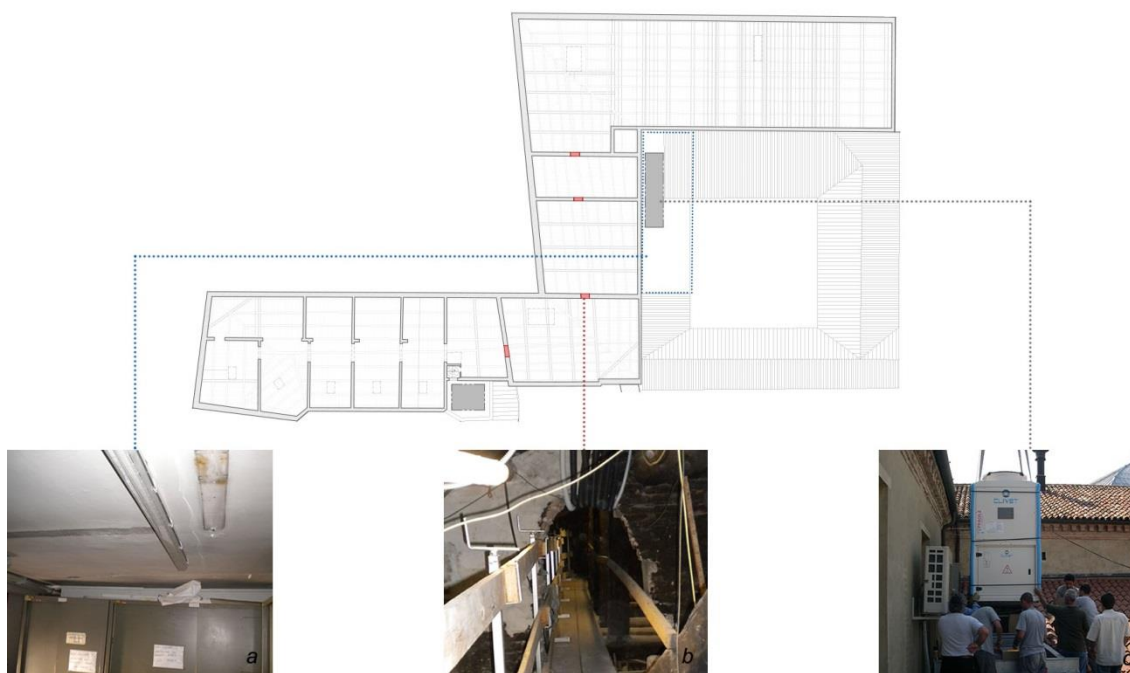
vulnerabilità in pianta, sottotetto; a) solai e cordoli in calcestruzzo armato; b) apertura di varchi nelle murature; c) elementi di massa rilevante.
